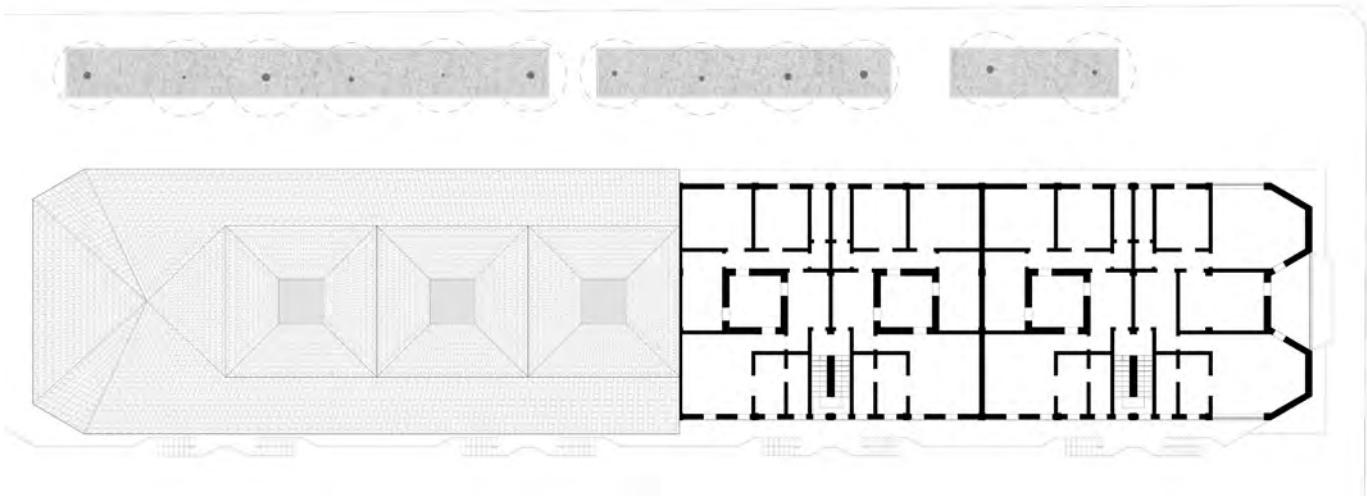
Pianta tipologica della corte aperta (Fonte: elaborazione dell'autore).
